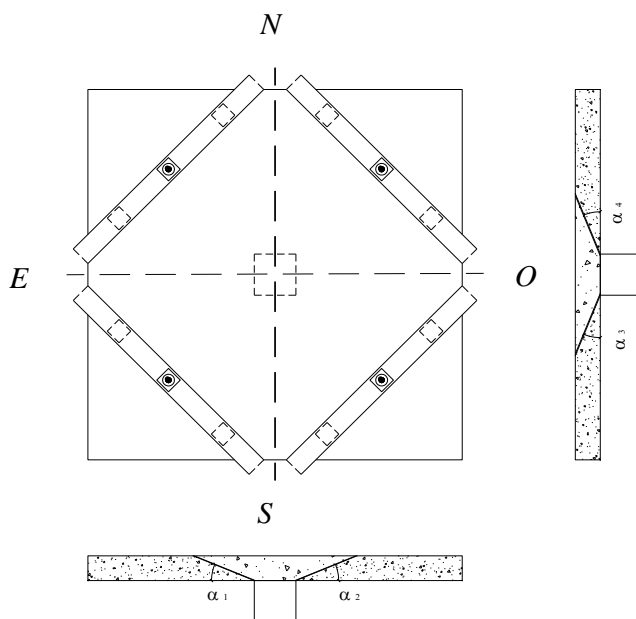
Inclinações da superfície de rotura com a horizontal [6]
